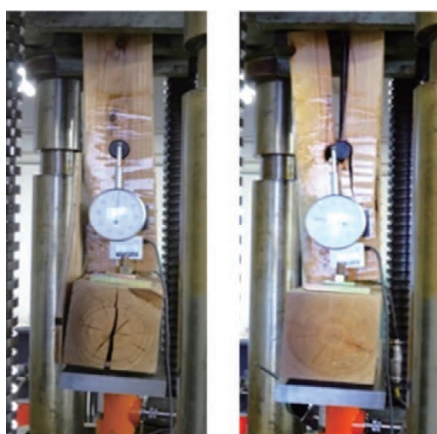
水平材のひび割れ (左) と鉛直材の割裂 (右)
